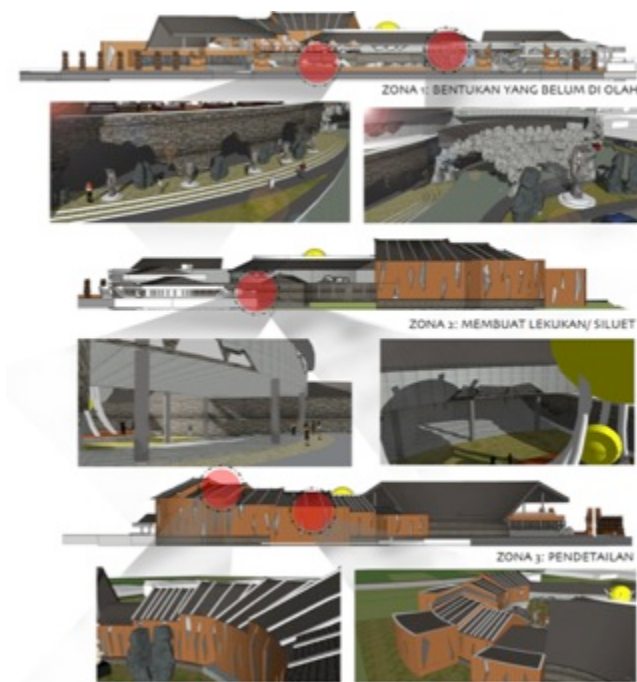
Penerapan Konsep ke dalam Layout Plan
